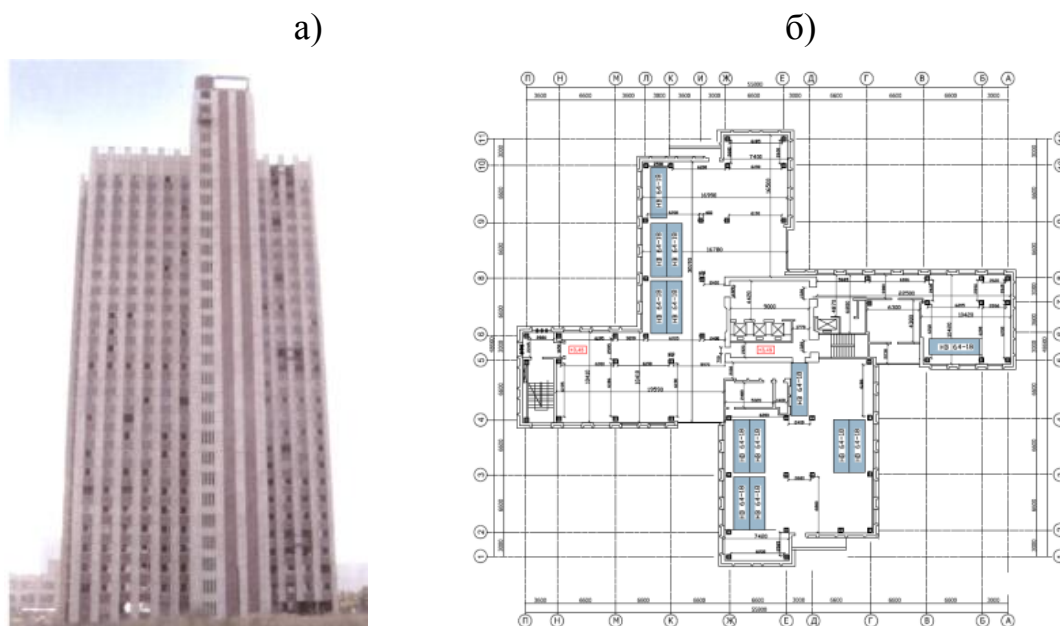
Вид здания, плиты перекрытия которого испытаны (а), и схема расположения испытываемых плит на типовом этаже (б)
